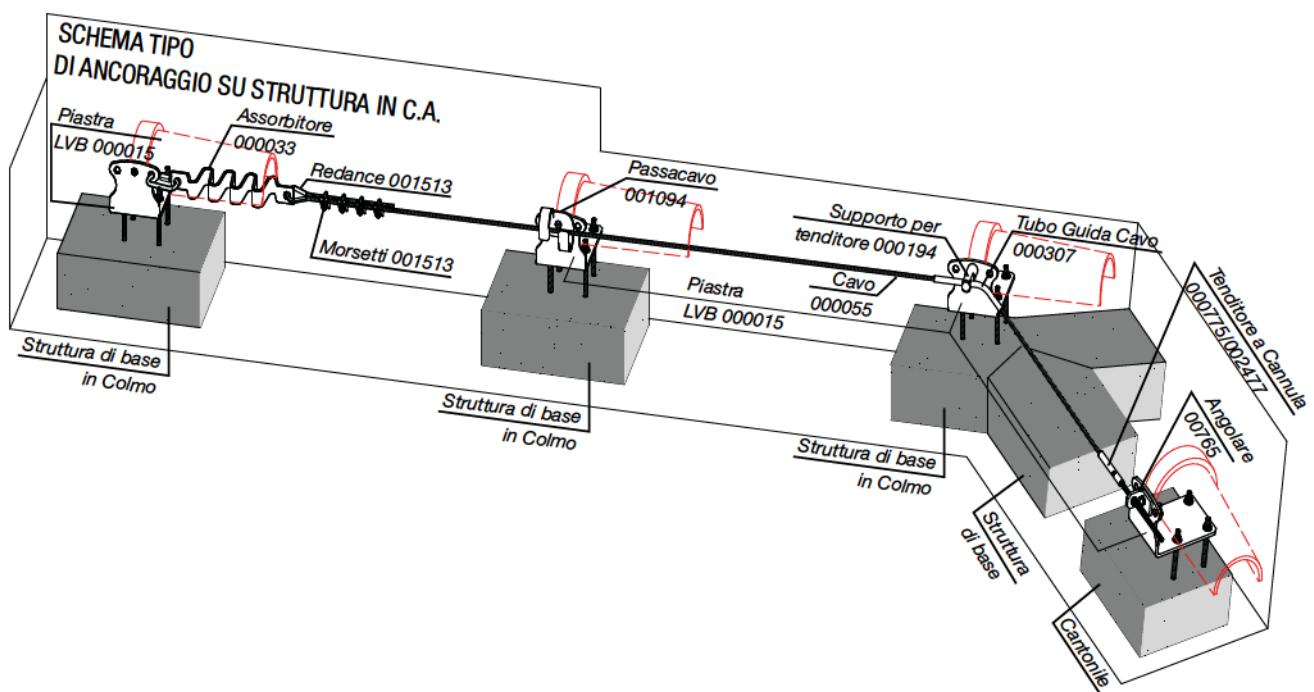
Linea vita LVB fissata su struttura di supporto in cemento.
